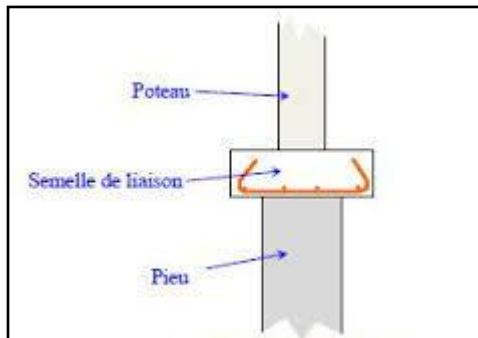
Liaison entre poteau-semelle-pieu source www.groupe-sma.fr
